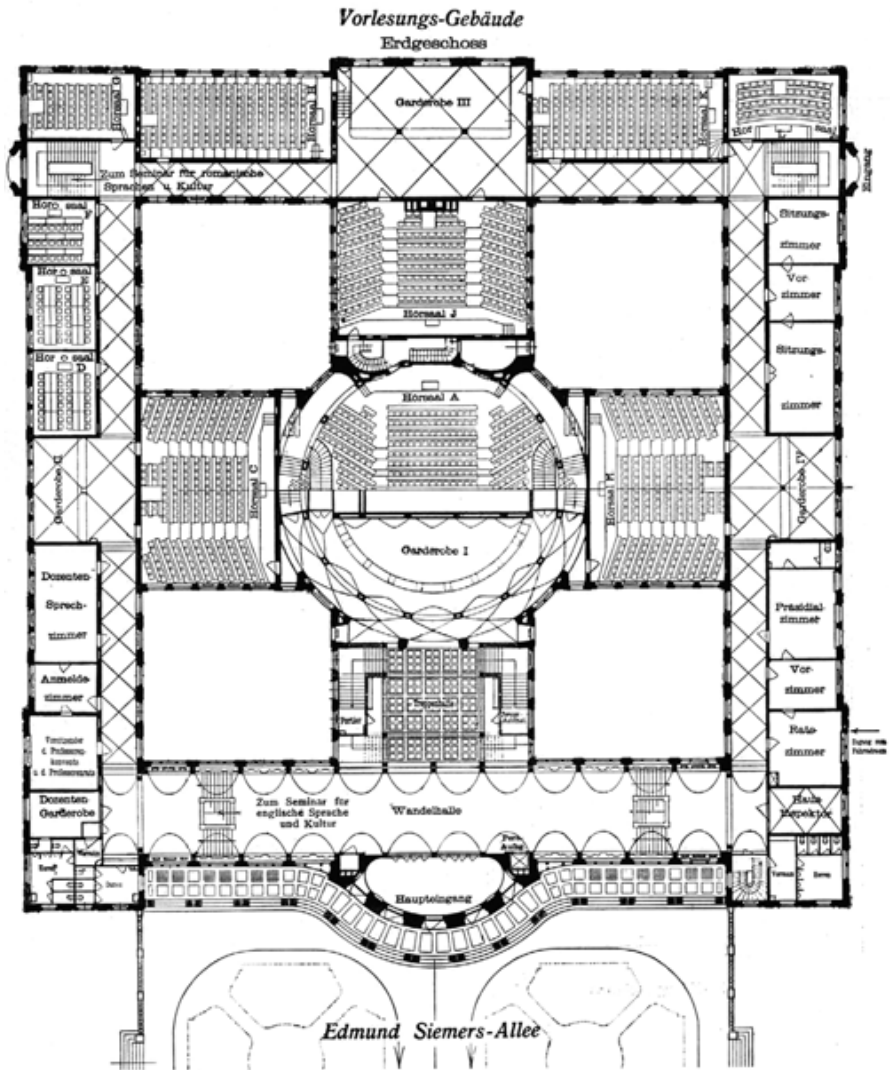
Überzeugende Struktur – Grundriss des Vorlesungsgebäudes 1911
